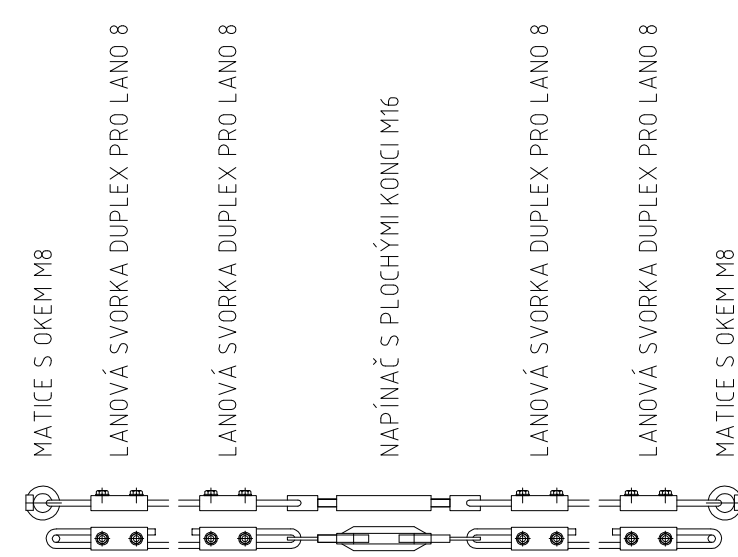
DETAIL NAPOJENÍ HORNÍ VÝZTUHY
